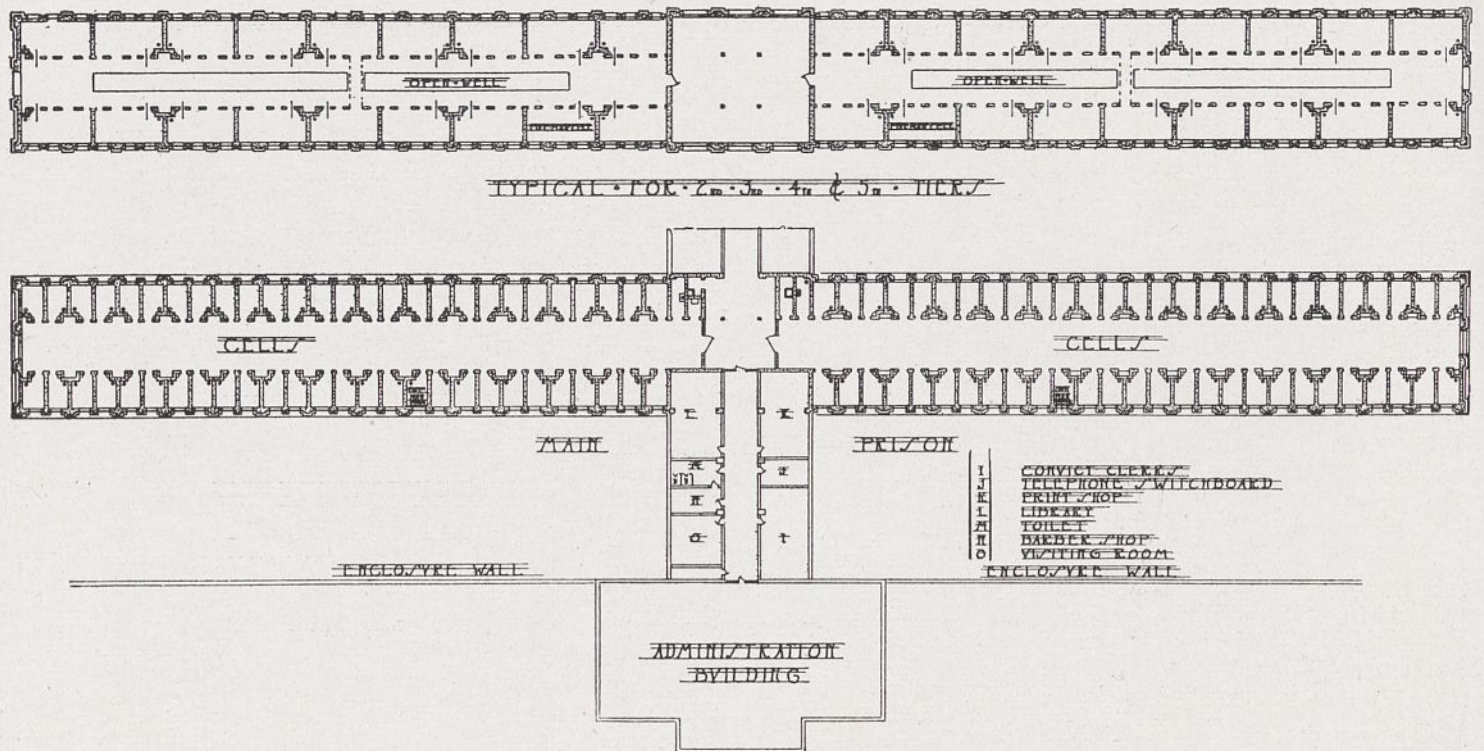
Kilby Prison bei Montgomery, Alabama. Grundrisse des Zellenblocks.
